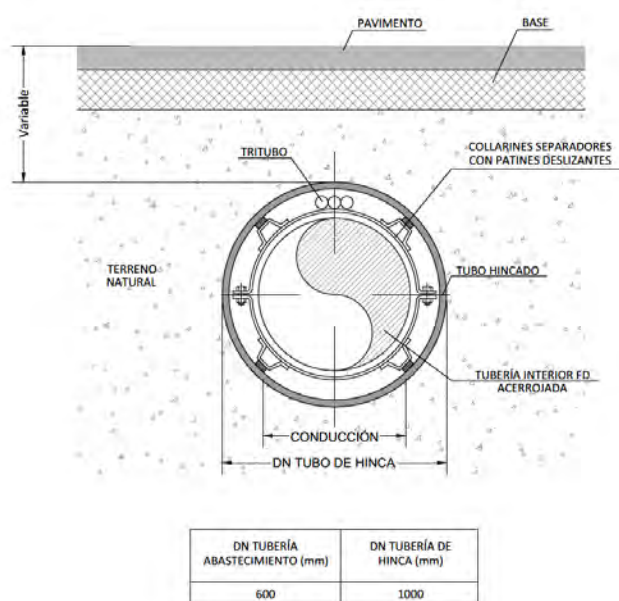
Sección tipo hincia 600 mm.
